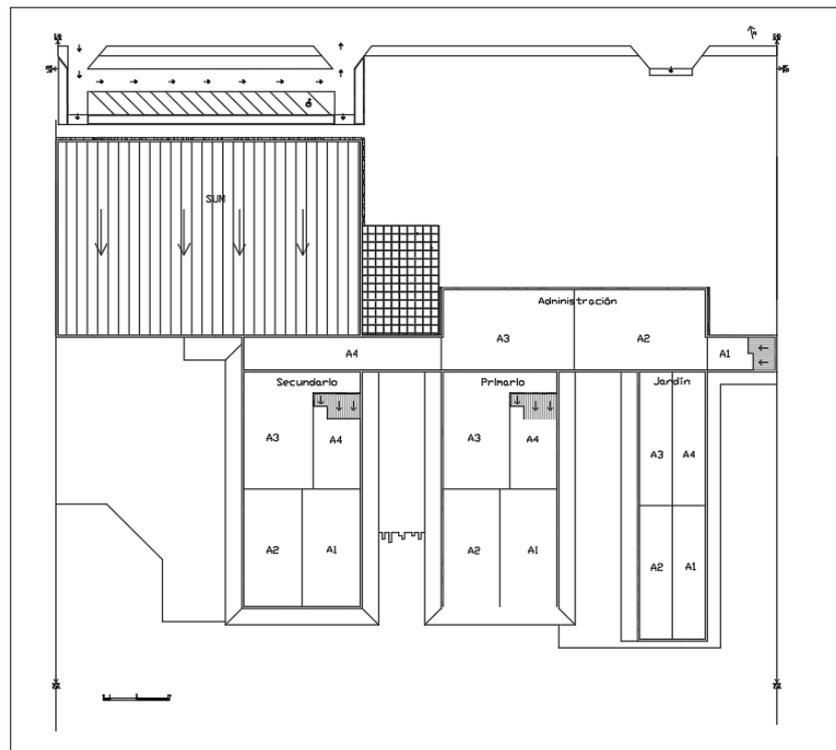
Plano de cubierta, división de áreas. Fuente: propia.
